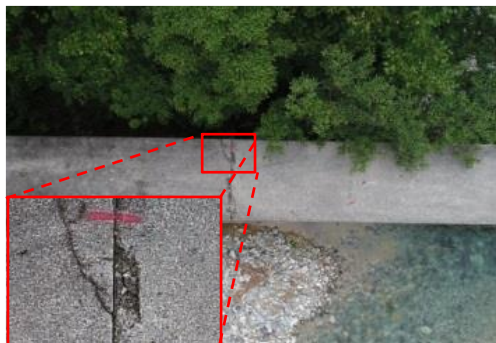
ひび割れ状況 (UAV) (垂直写真の拡大)
